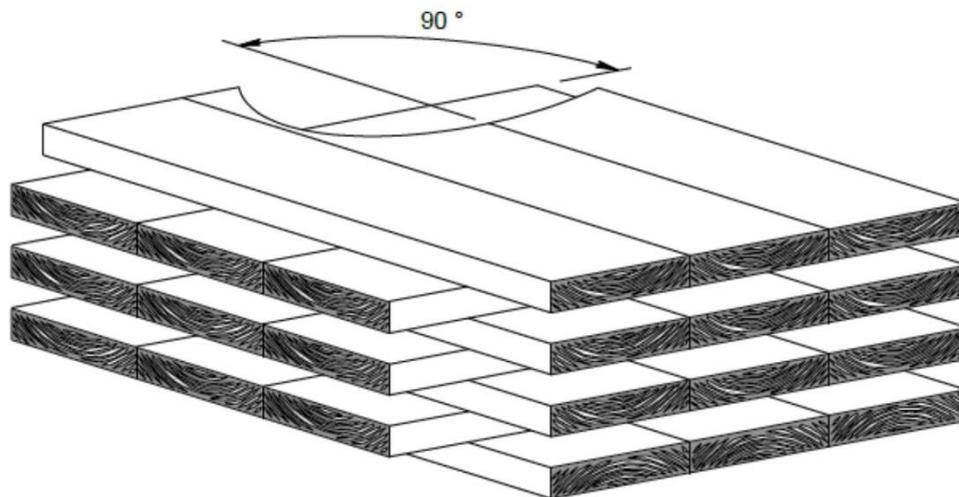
Structure typique d'un panneau structural en bois contre-croisé
